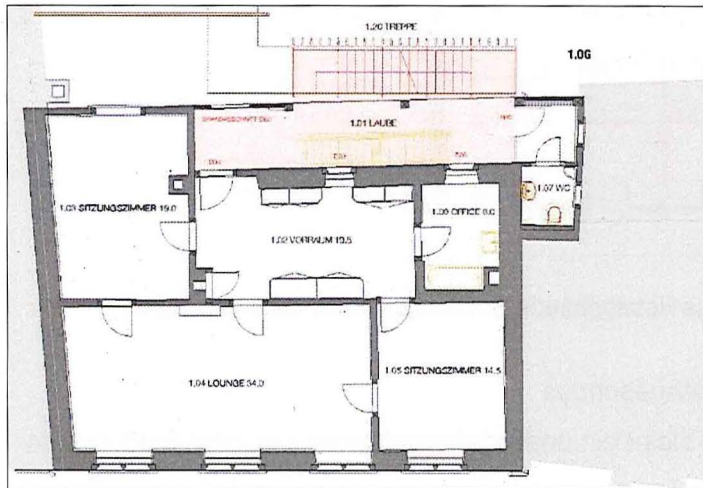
Grundriss Hotelgebäude, 1. Obergeschoss
